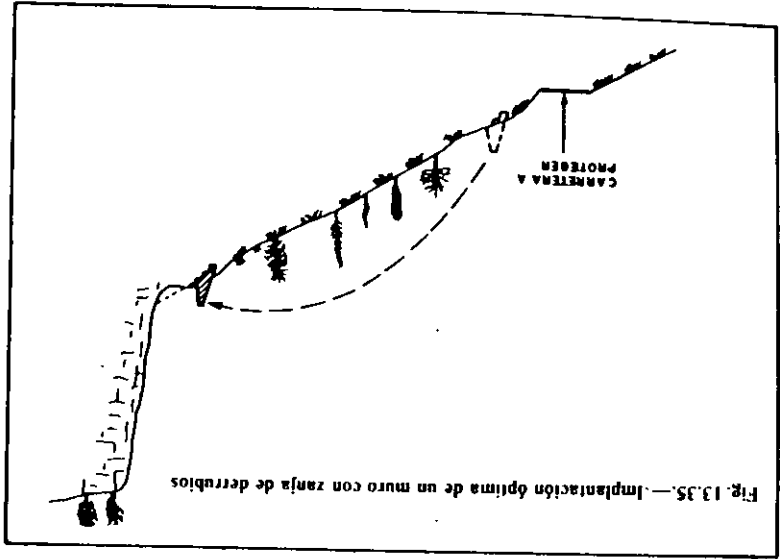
Implantación óptima de un muro con zanja de derrubios
